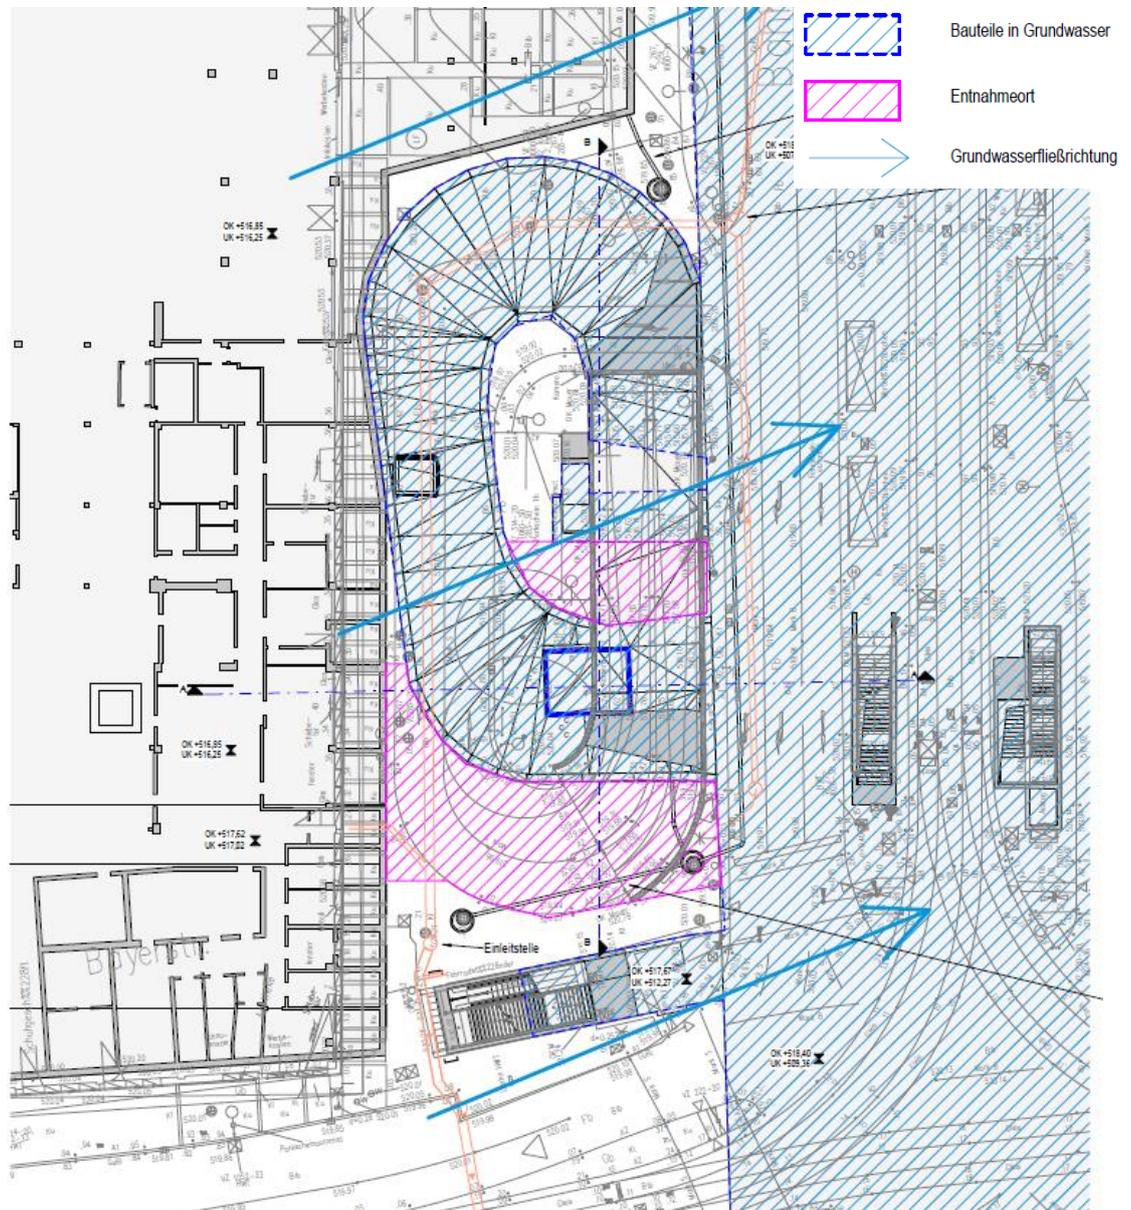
Ausschnitt aus dem Lageplan (Anlage 18.6.2 Wasserhaltung am Lastenaufzug Lageplan)
